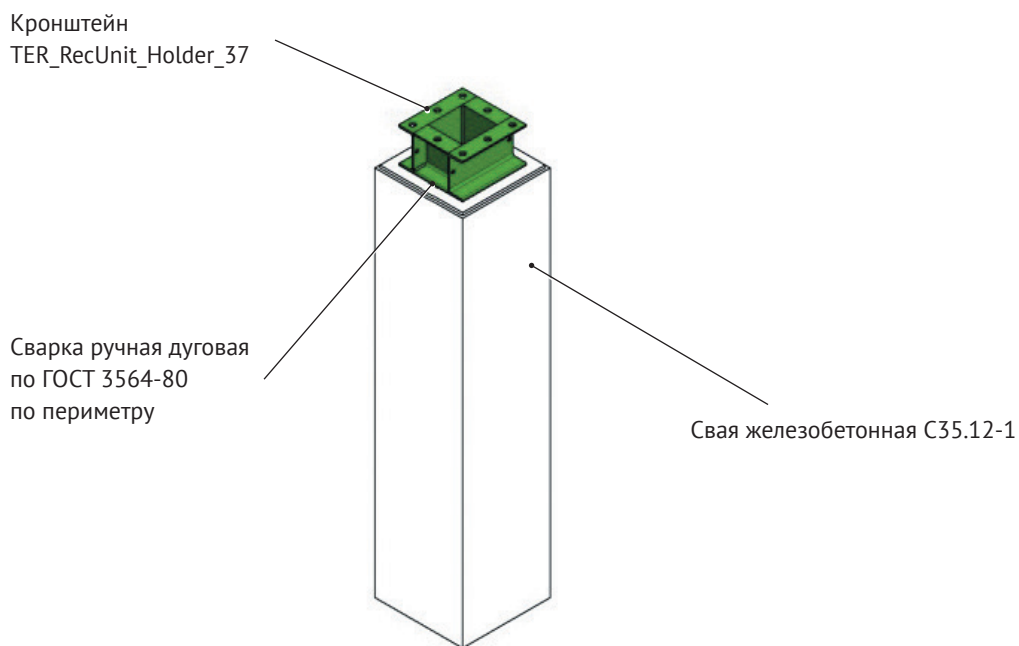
Крепление сваркой кронштейна к металлическому оголовку сваи типа С35
